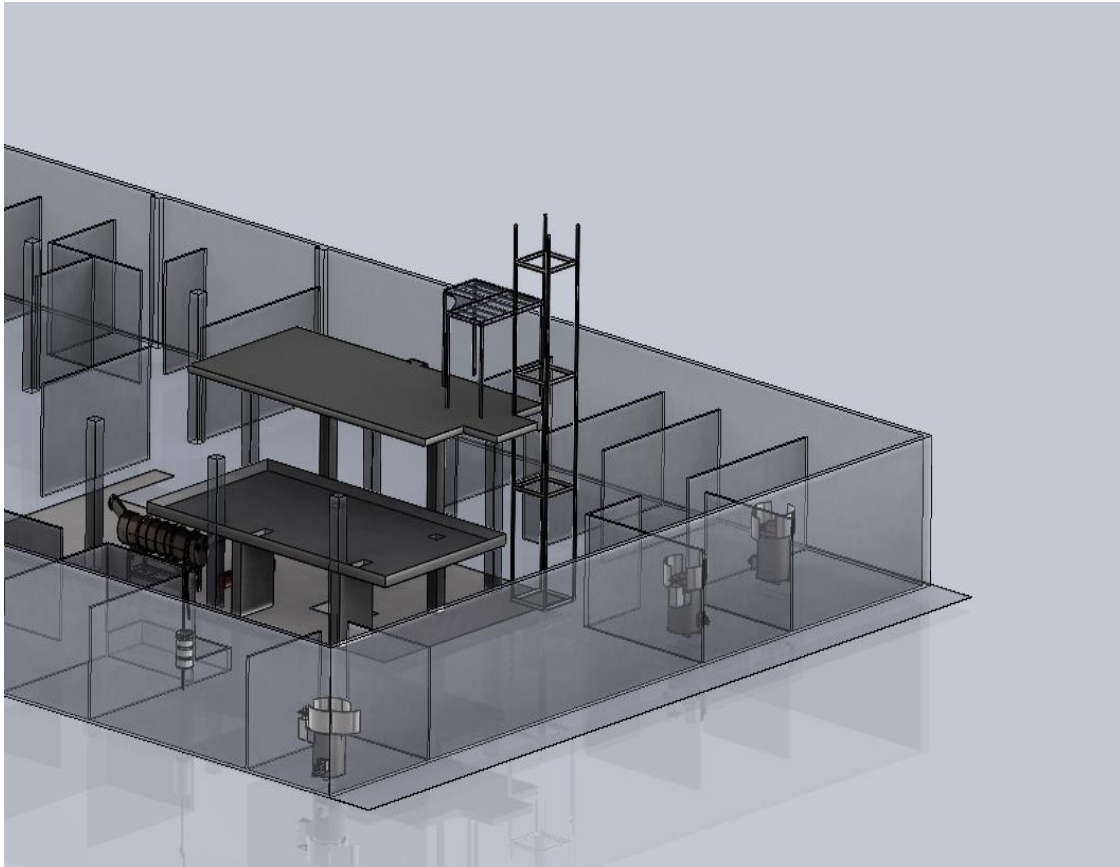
Plano de la planta donde se centrara el proyecto. (Esquema suministrado por industrias EMU. S.A.)
